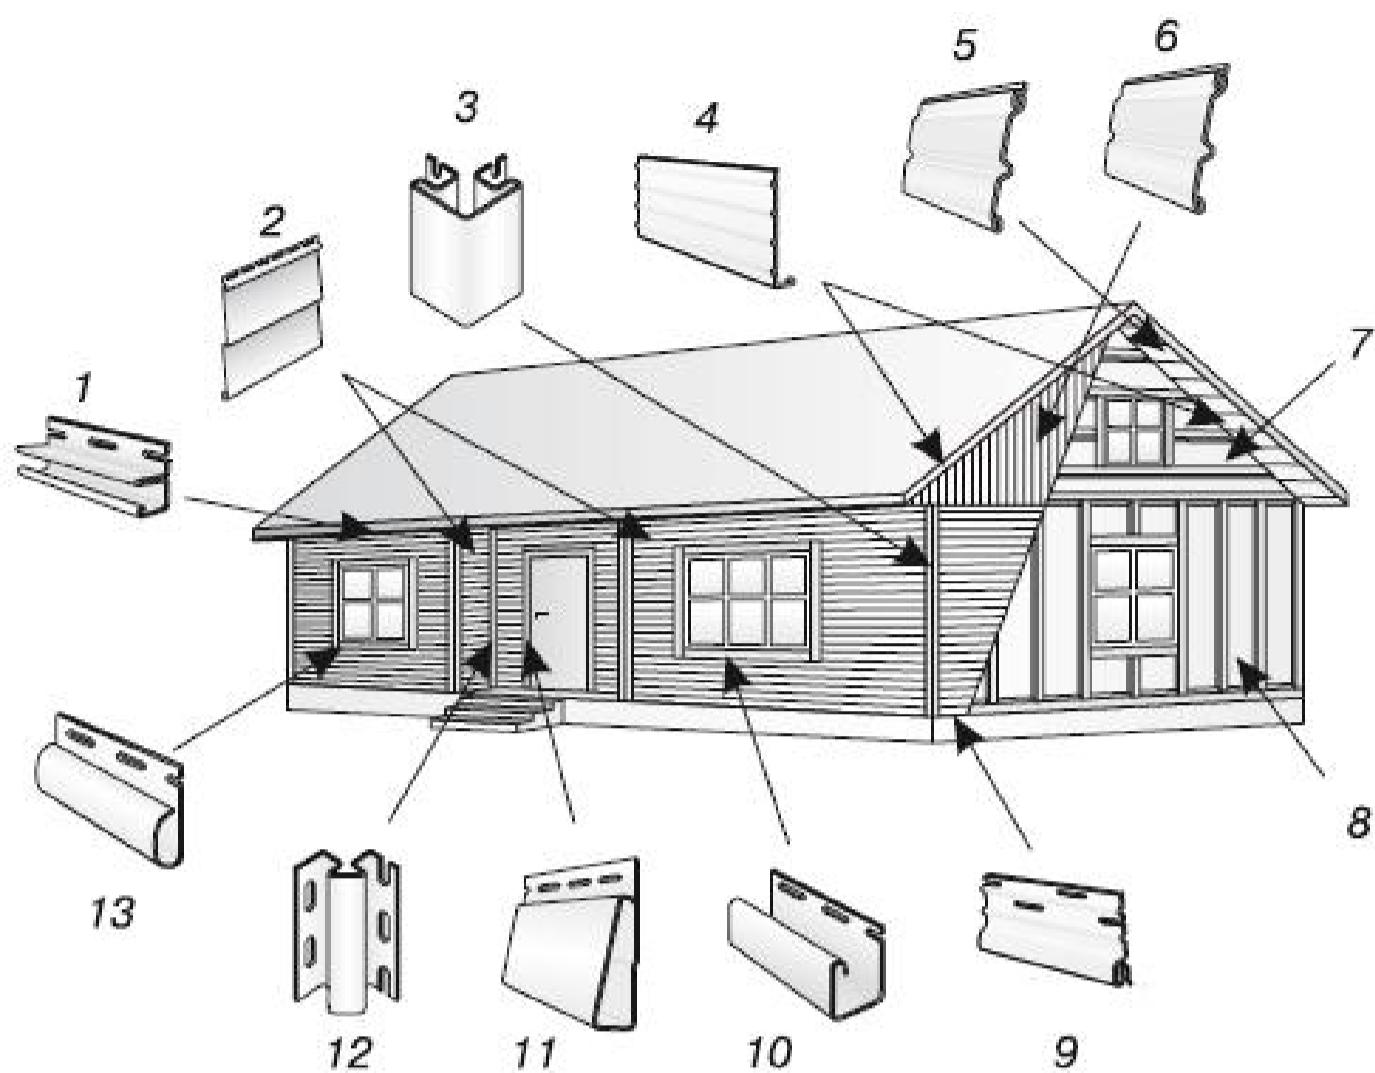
Расположение сайдинга на фасадах: 1 – F-профиль; 2 – горизонтальный сайдинг; 3 – стойка внешнего угла; 4 – фаска (карнизная панель); 5 – софит; 6 – вертикальный сайдинг; 7 – образец обрешетки для вертикальной установки сайдинга; 8 – образец обрешетки для горизонтальной установки сайдинга; 9 – стартовая полоса; 10 – J-профиль; 11 – наличник; 12 – стойка внутреннего угла; 13 – завершающая накладка
